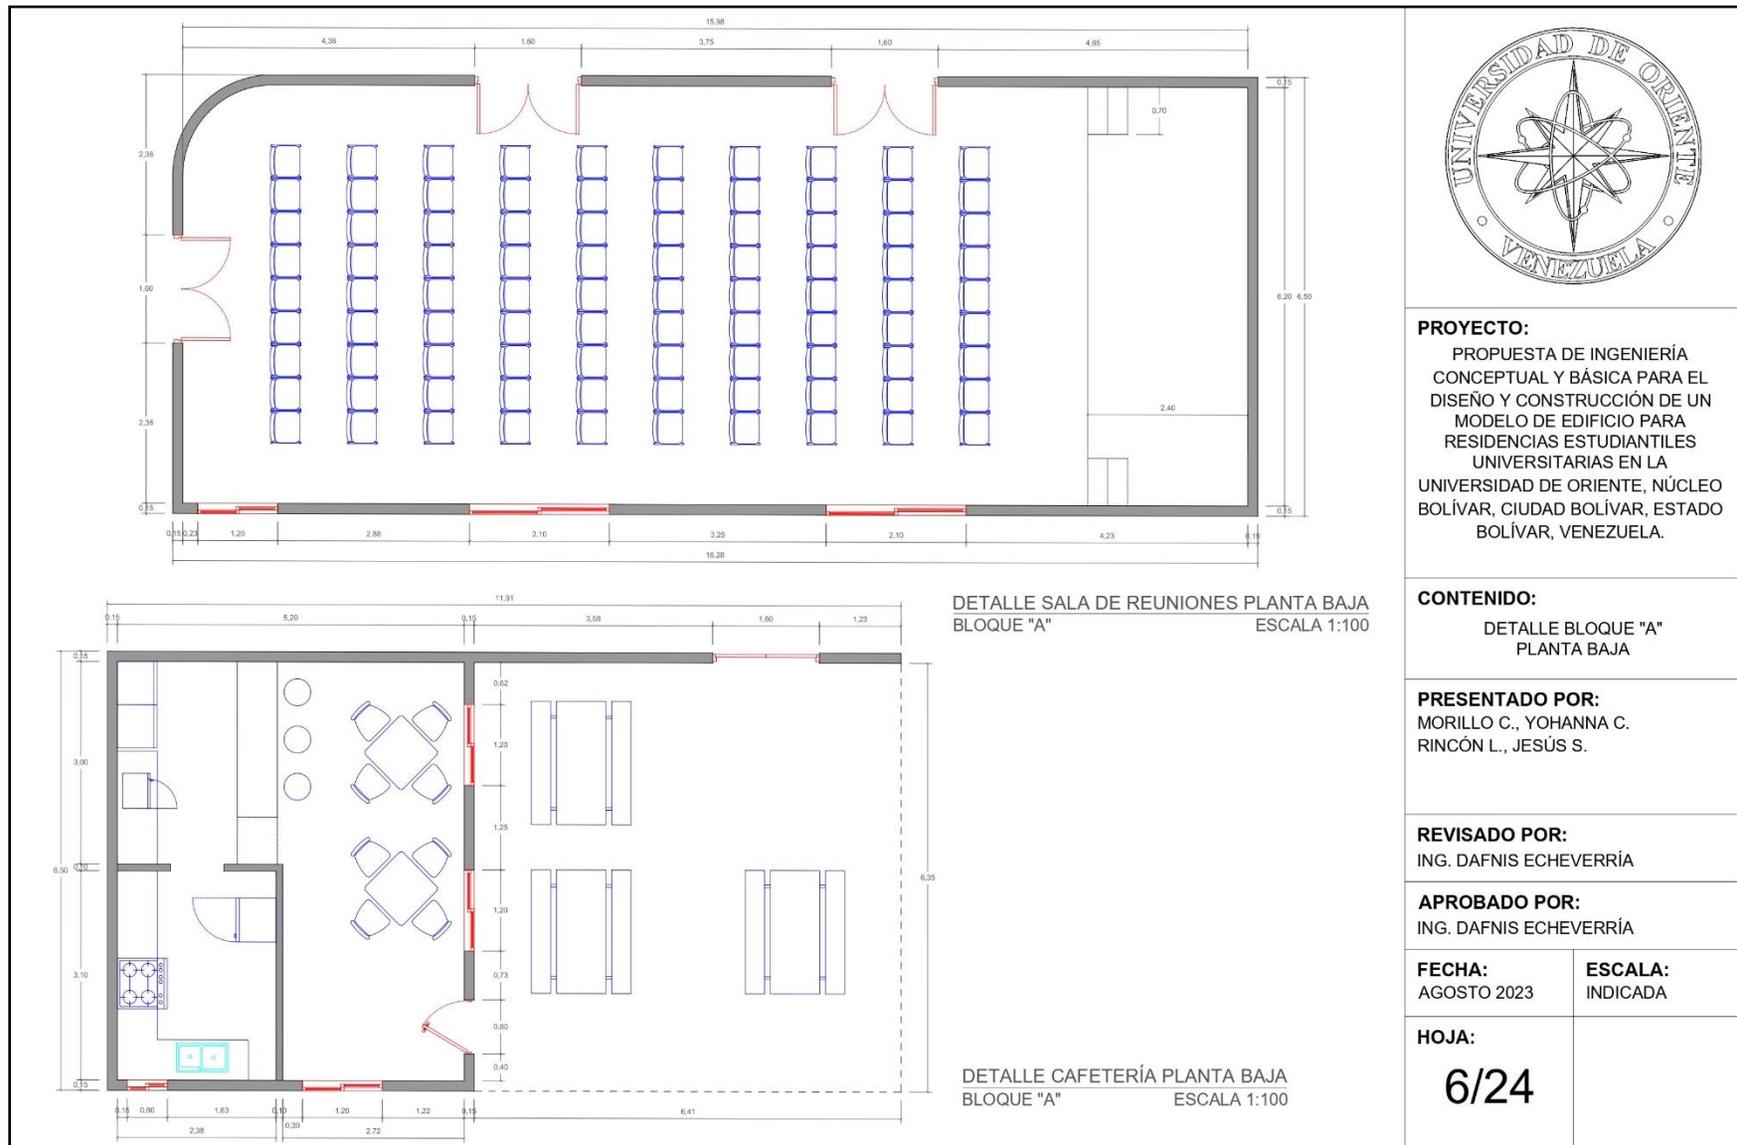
Plano de Detalle. Bloque “A”, planta baja.
